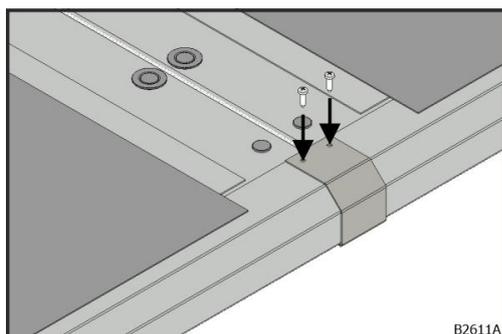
assemblage de la pièce de recouvrement de la cornière casse-goutte
